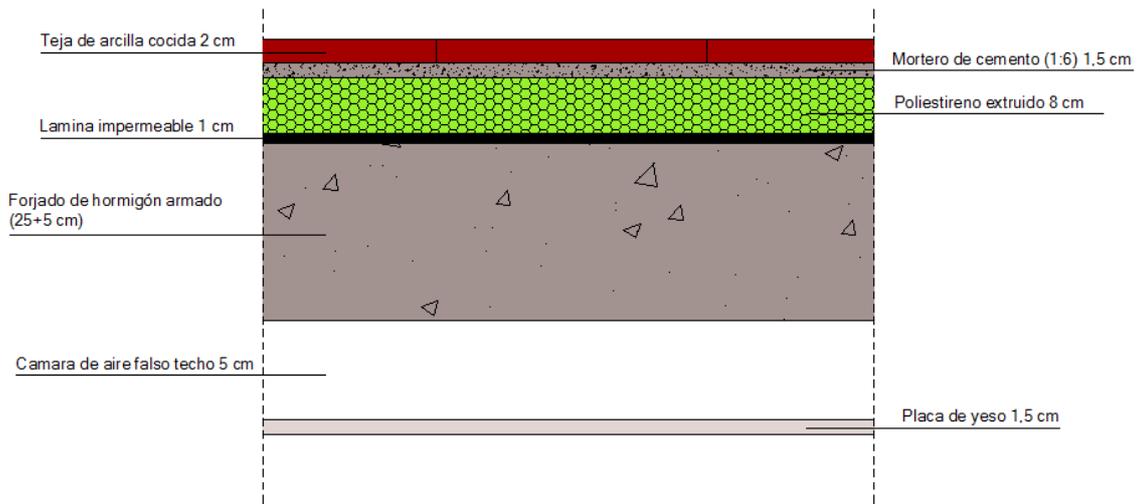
Detalle cubierta tipo 1 propuesta.2014.CAD.
